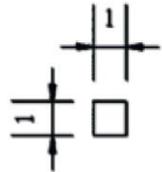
Dimensiones de las secciones transversales de elementos estructurales, dimensiones en cm.
